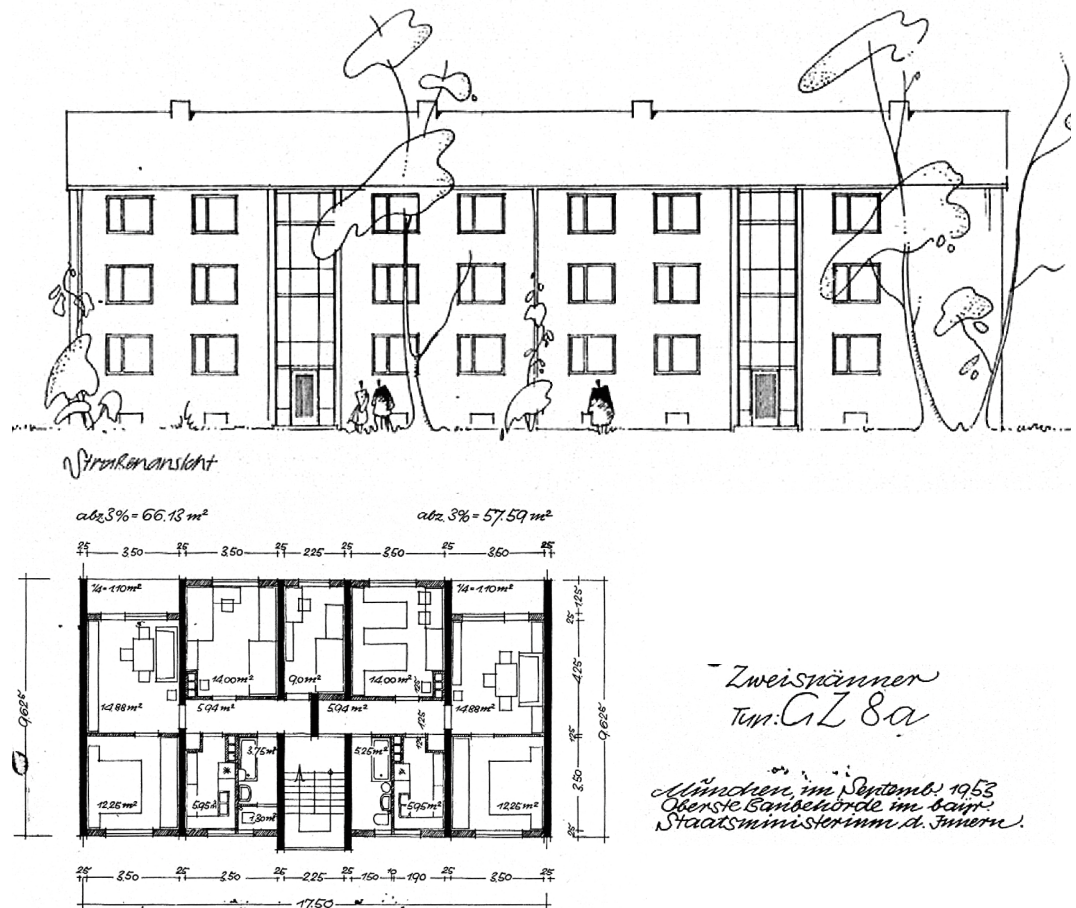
Typischer Grundriss für ein Gebäude aus den 50er Jahren, aus: Reinhard, Sozialer Wohnungsbau in Bayern, München, 1957
